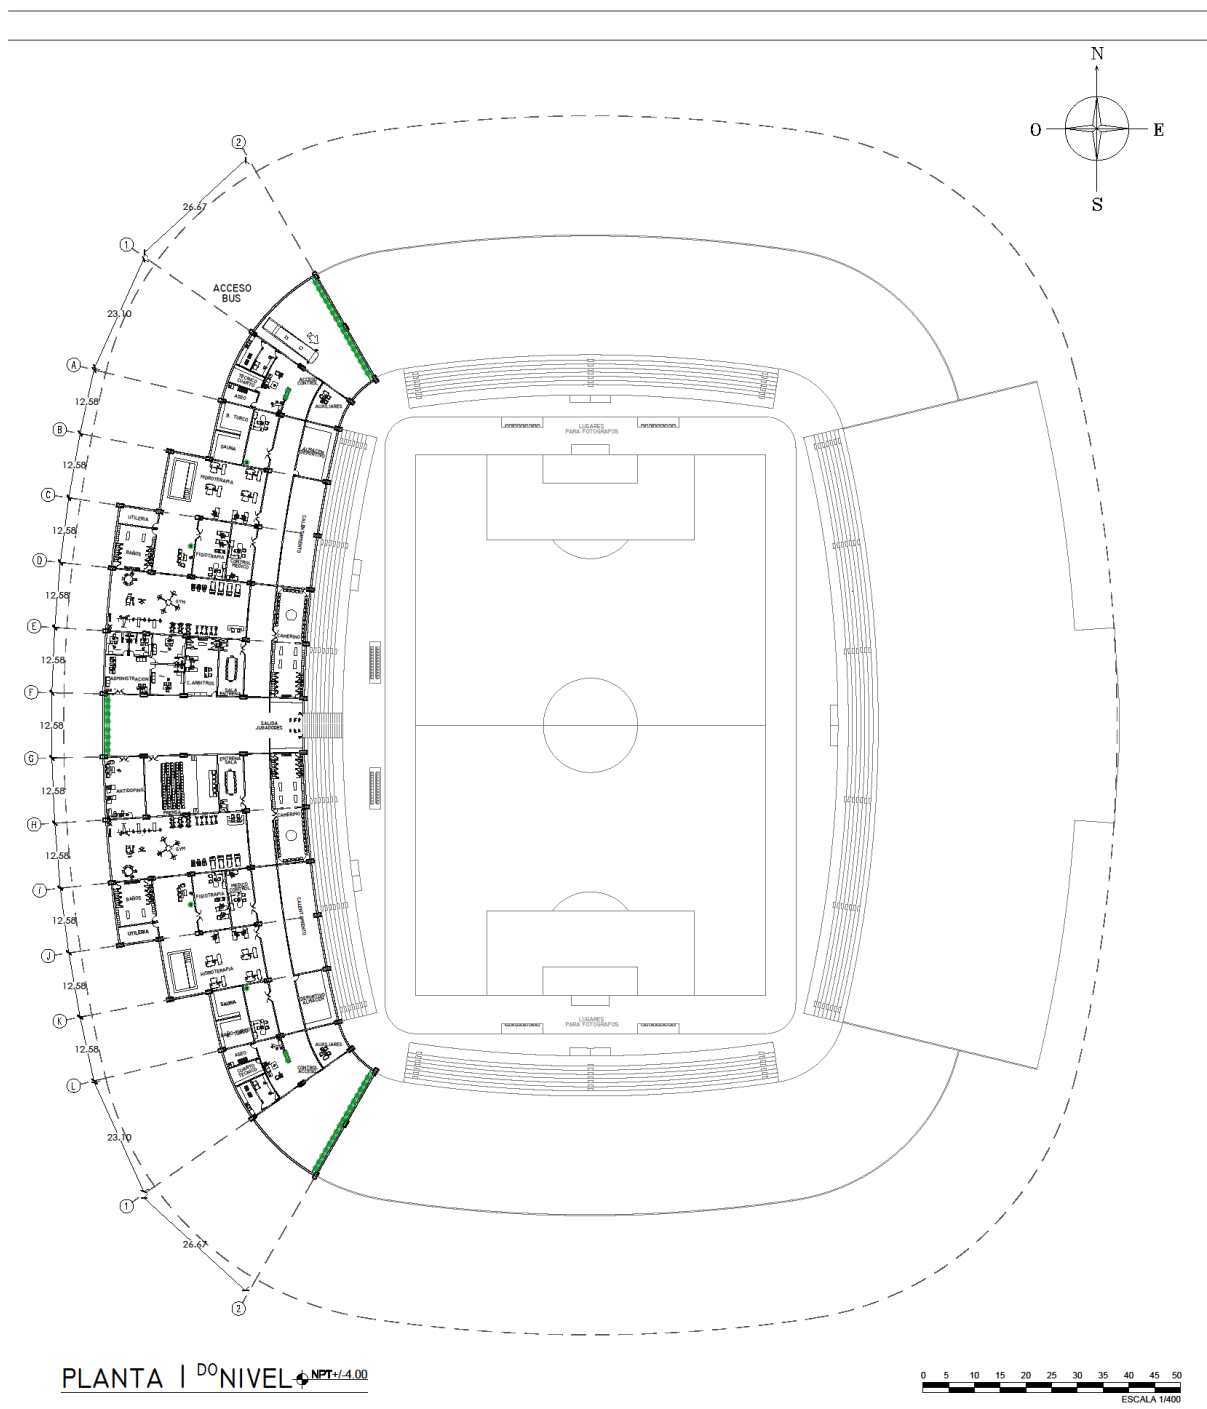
Planta 1 / Fuente Elaboración Propia
